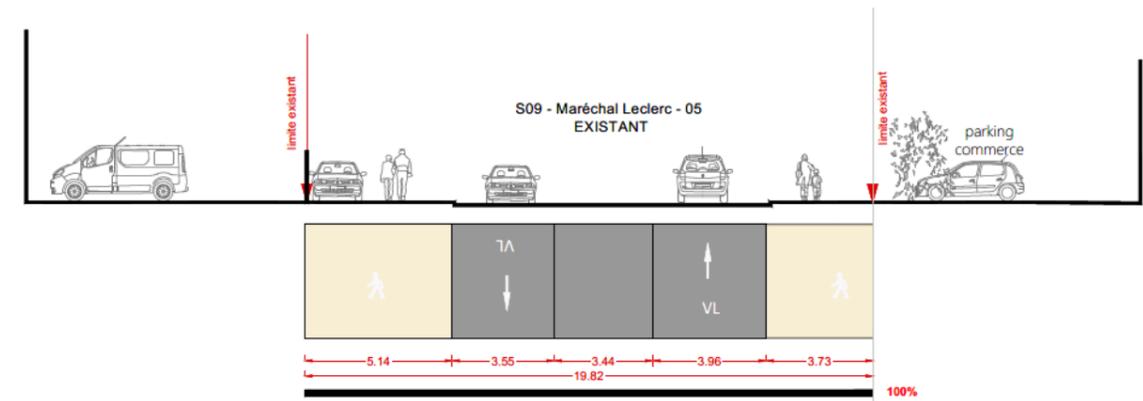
Profil existant de l'avenue Maréchal Leclerc
